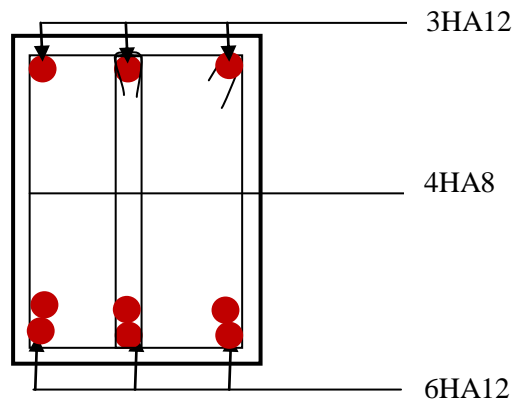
Ferrailage en travée d'une poutre principale.
